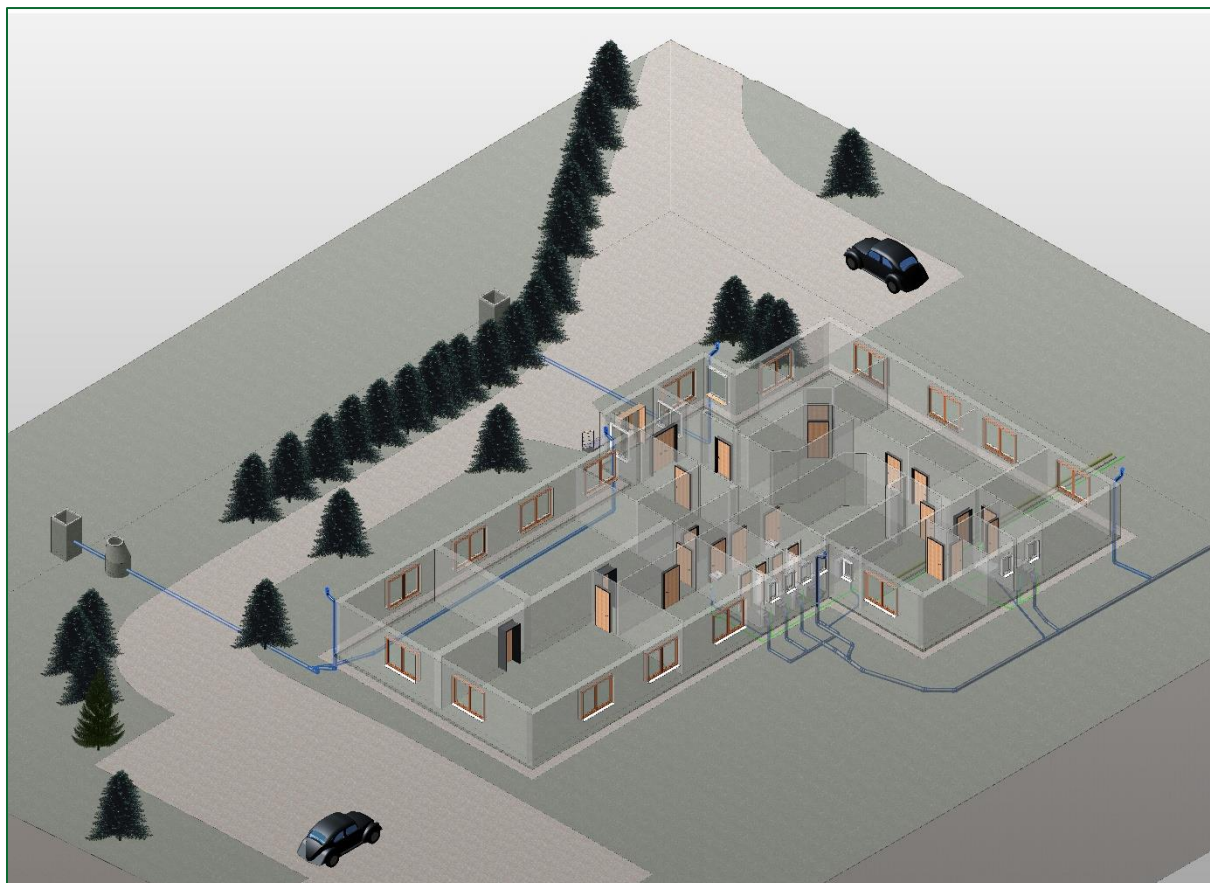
3D Revit Gebäudeansicht mit Versorgungsleitungen
